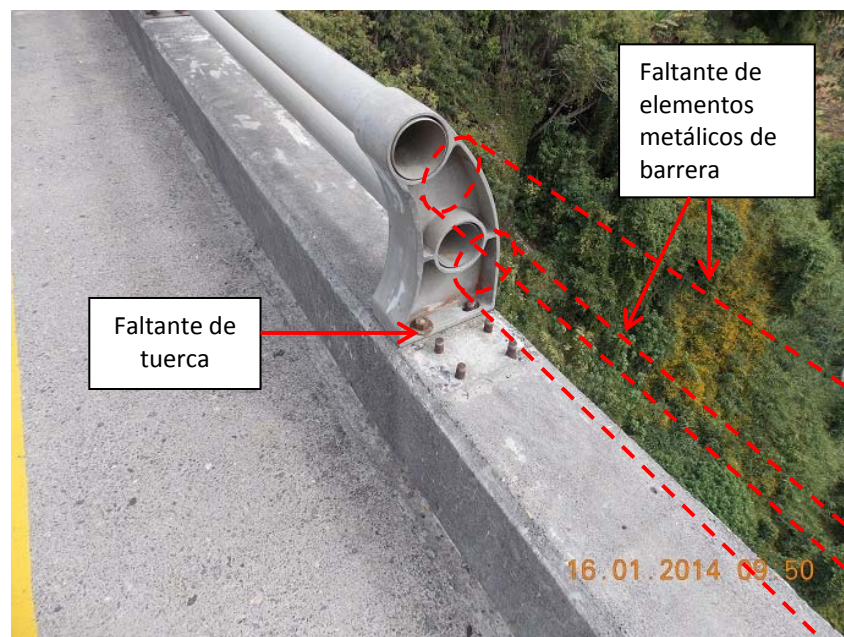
Faltante de elementos metálicos y tuercas en la barrera del costado este.
